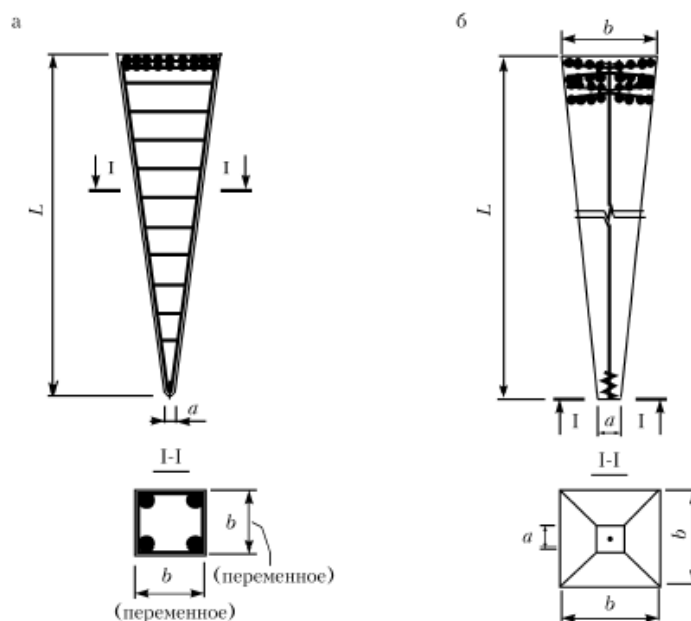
Пирамидальные сваи: а) с поперечным армированием ствола;
